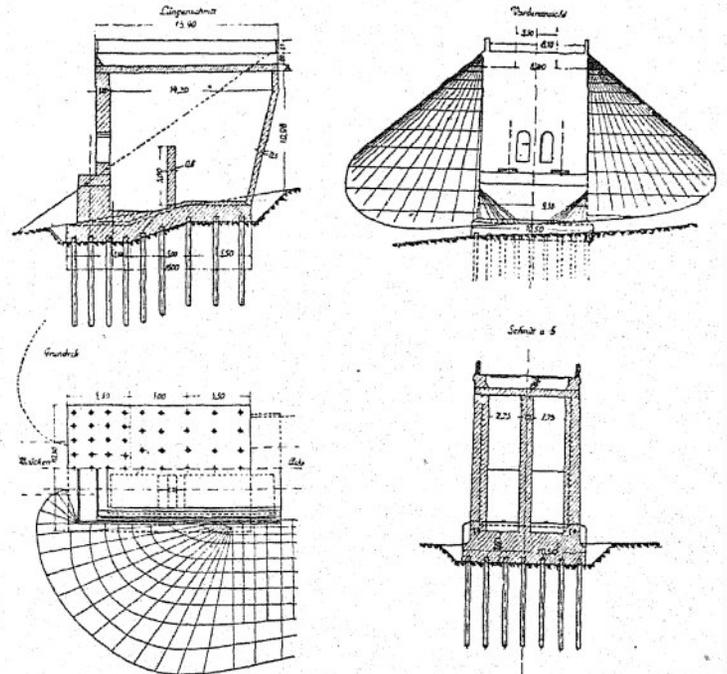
Ansicht, Längsschnitt, Querschnitt, Grundriß und Draufsicht des Endwiderlagers.
